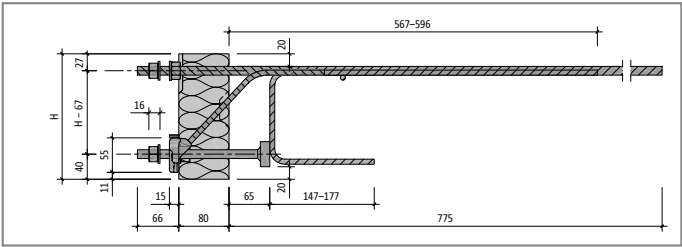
Schöck Isokorb® T Typ SK-M1-V1: Produktschnitt
